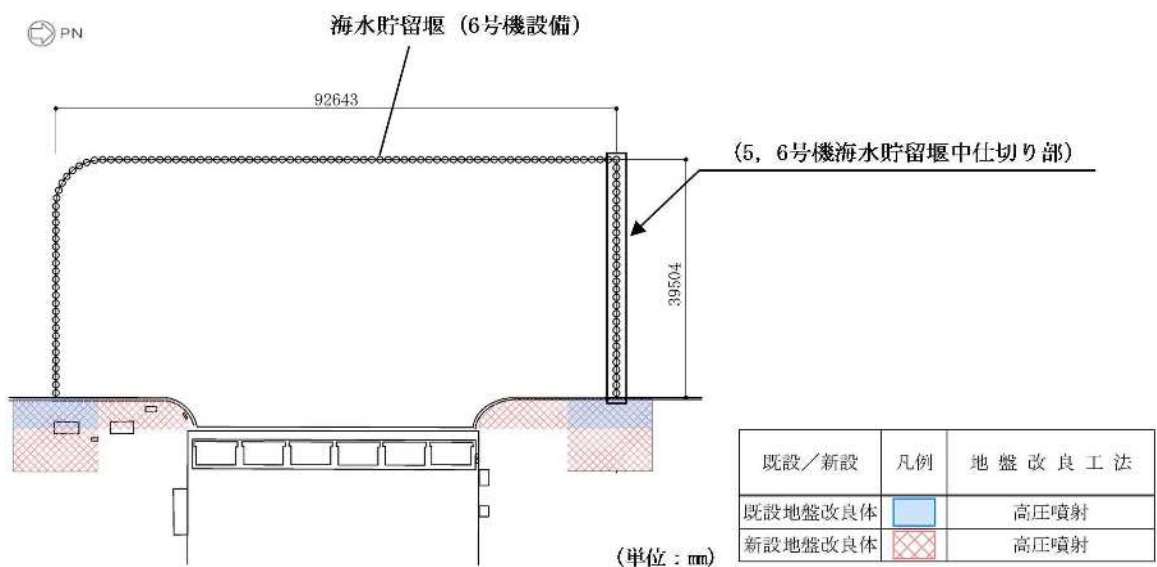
海水貯留堰 (6号機設備) の平面図
